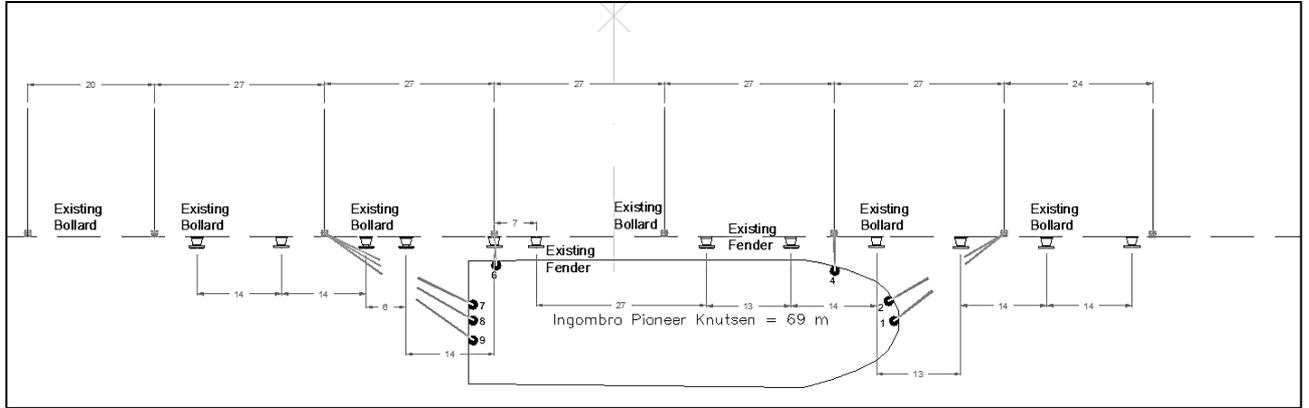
Layout Sistema di Ormeaggio previsto per le LNG Carrier e le bettoline
